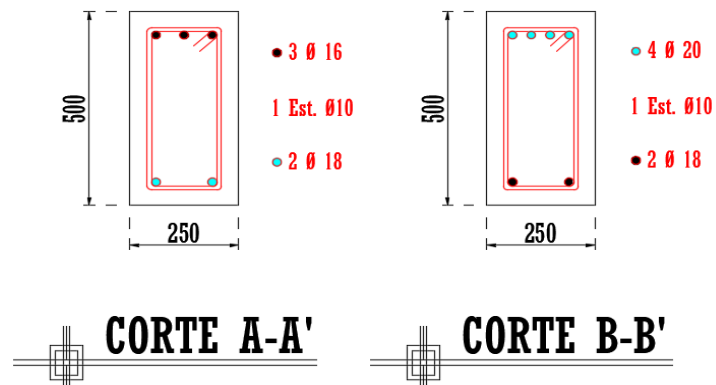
Sección de viga secundaria piso 2-3-4.
